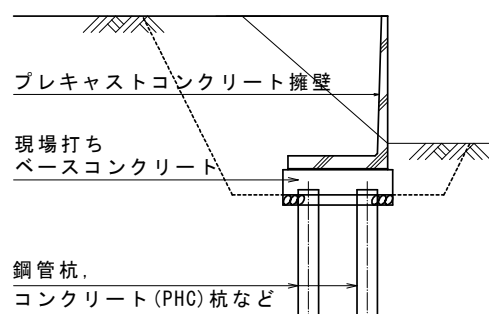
プレキャストコンクリート擁壁と杭基礎の結合例
